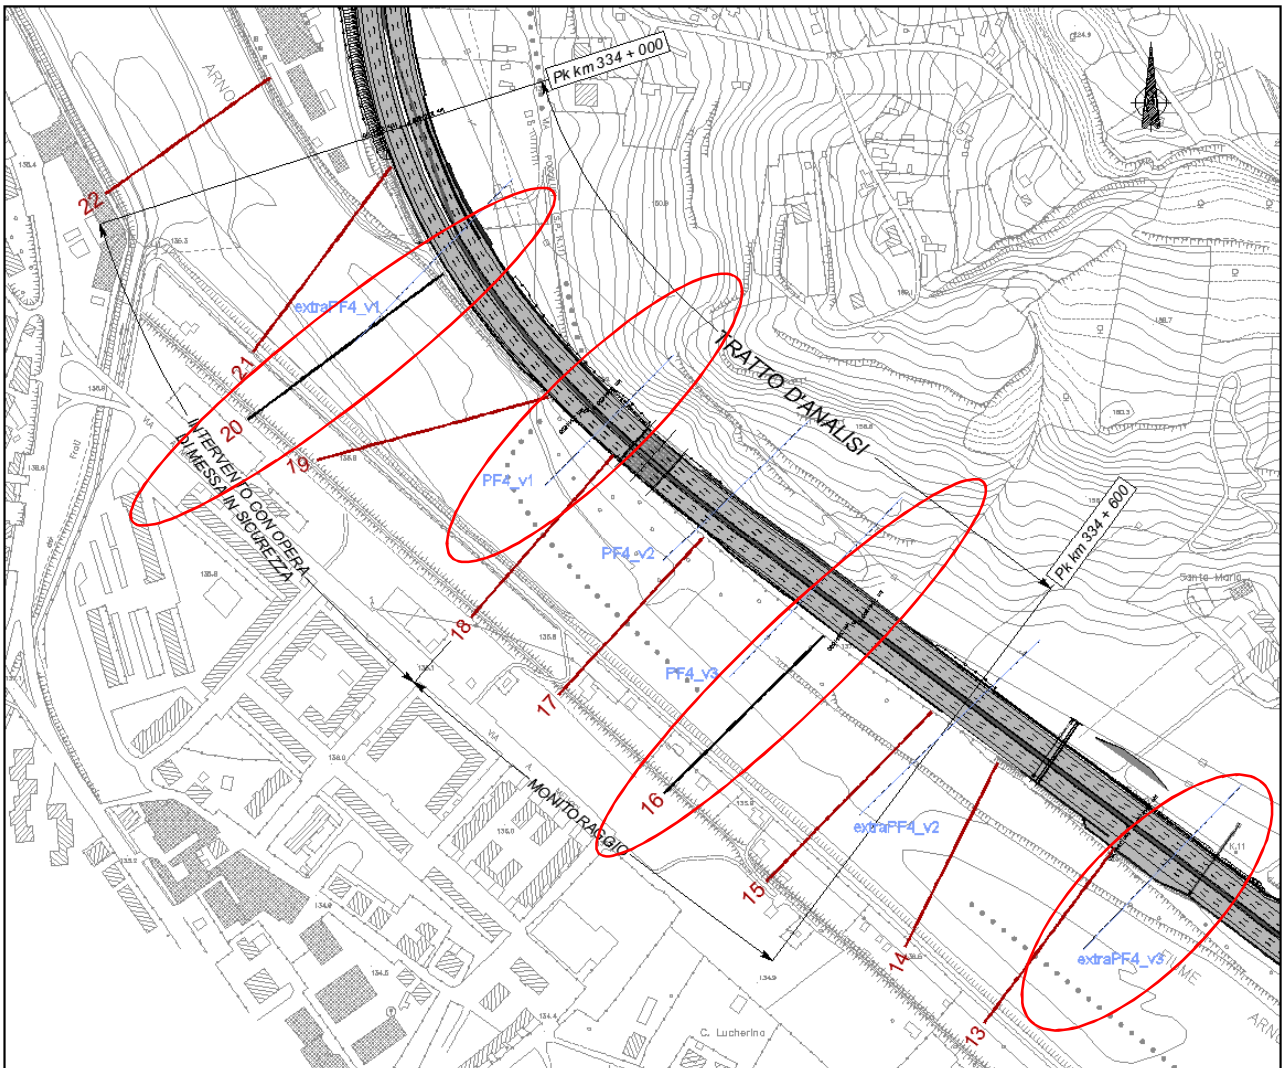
Stralcio planimetrico con ubicazione delle sezioni
